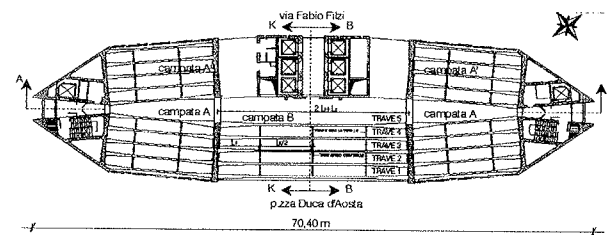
Pianta dell'impalcato tipo del palazzo Pirelli
